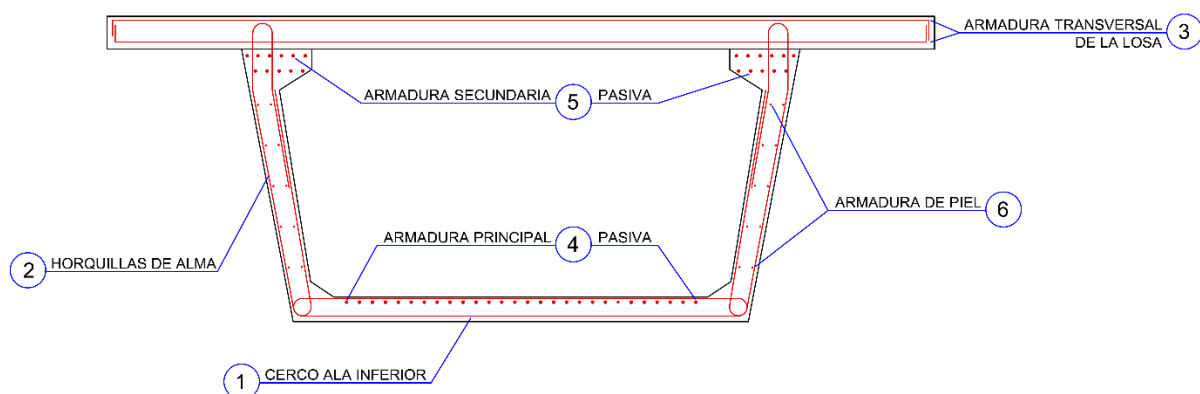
Esquema de disposición del montaje de la armadura en el vano central
